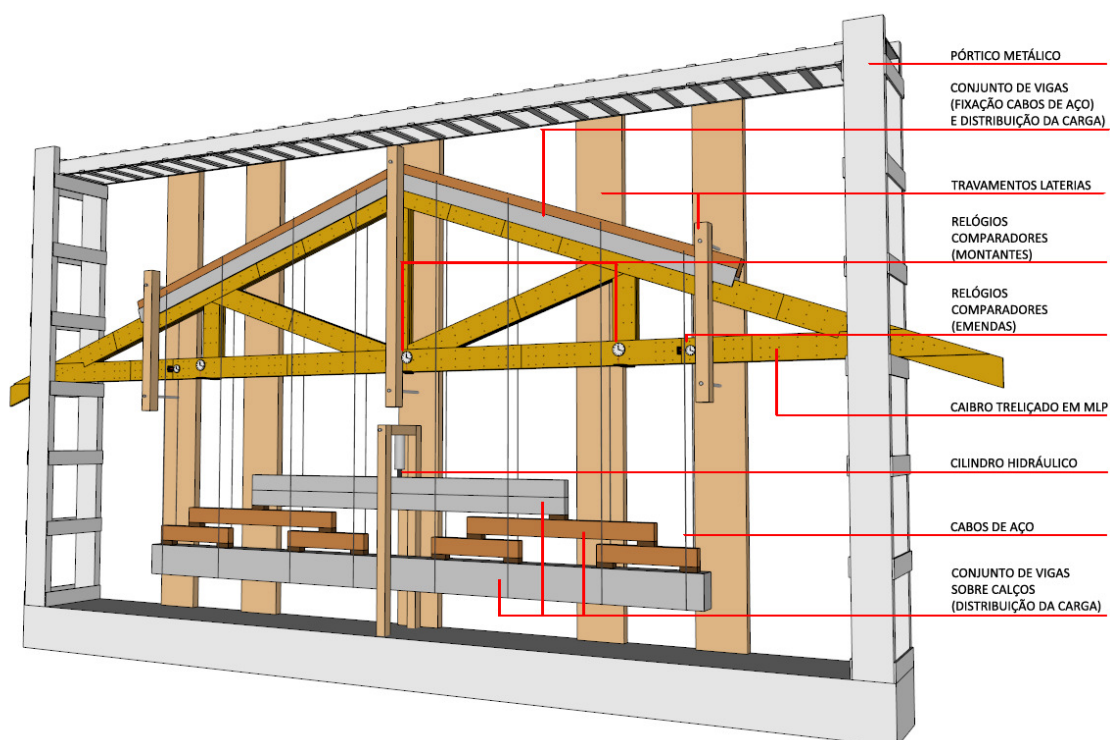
Croqui com as especificações dos instrumentos e equipamentos utilizados no ensaio destrutivo do Caibro treçado em MLP.
